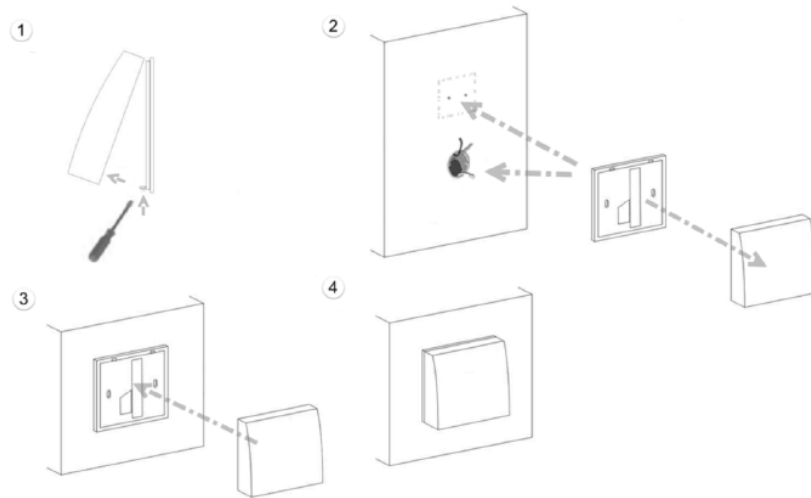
Montage des Sensors (Quelle: Thermokon)
